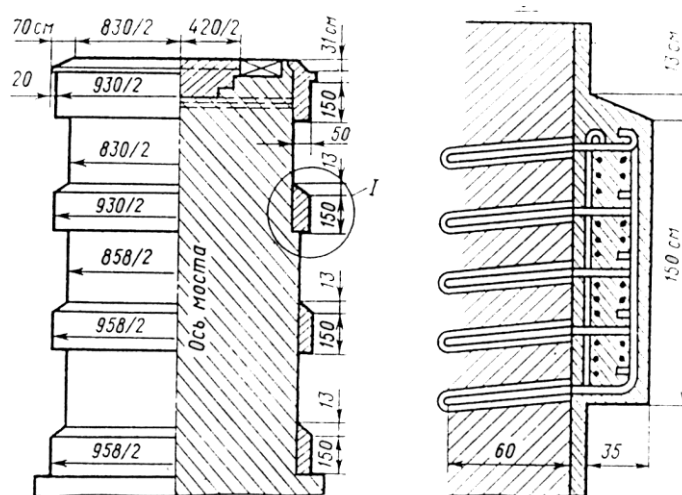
Схема усиления промежуточной опоры железобетонными поясами
